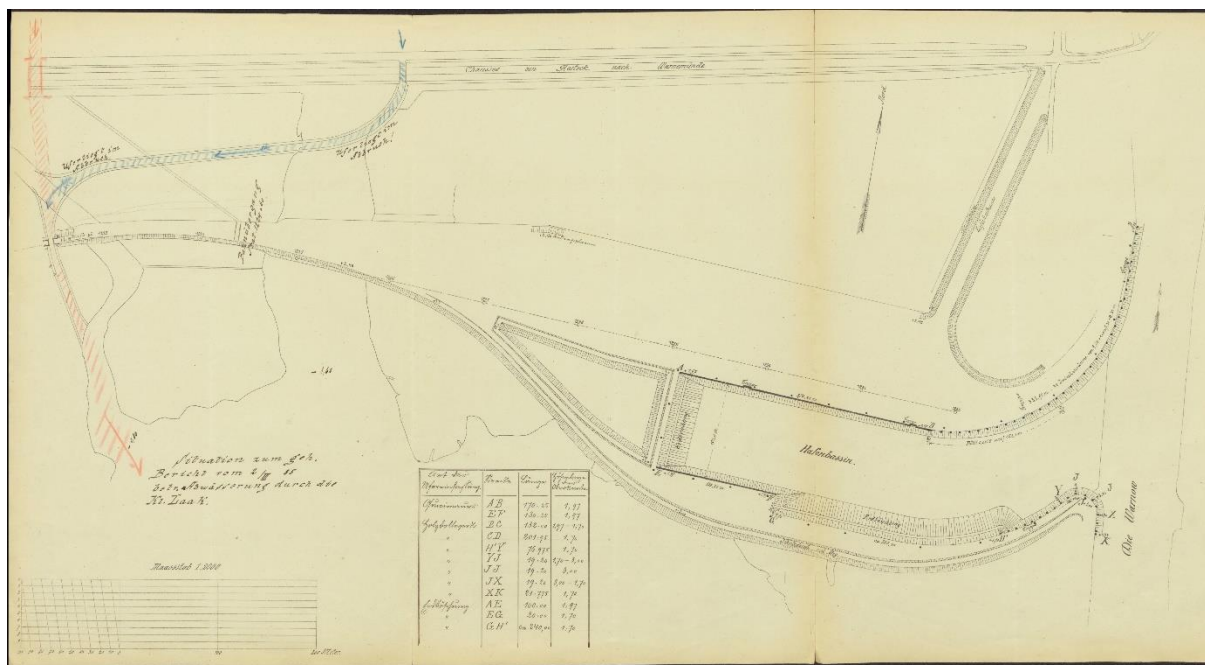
Modifizierter Lageplan mit eingezeichnetem Laakkanal (KERNER 1885)
